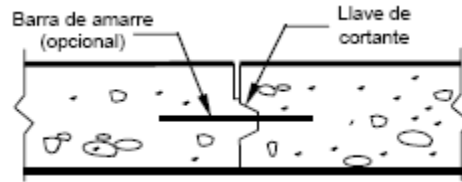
Junta longitudinal, pavimentación por franjas.
